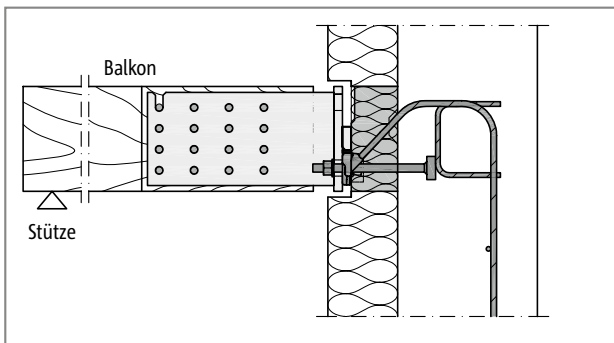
Schöck Isokorb® T Typ SQP-WU mit Stahlschwert: Sonderkonstruktion; erforderlich bei Anschluss an eine Stahlbetonwand
